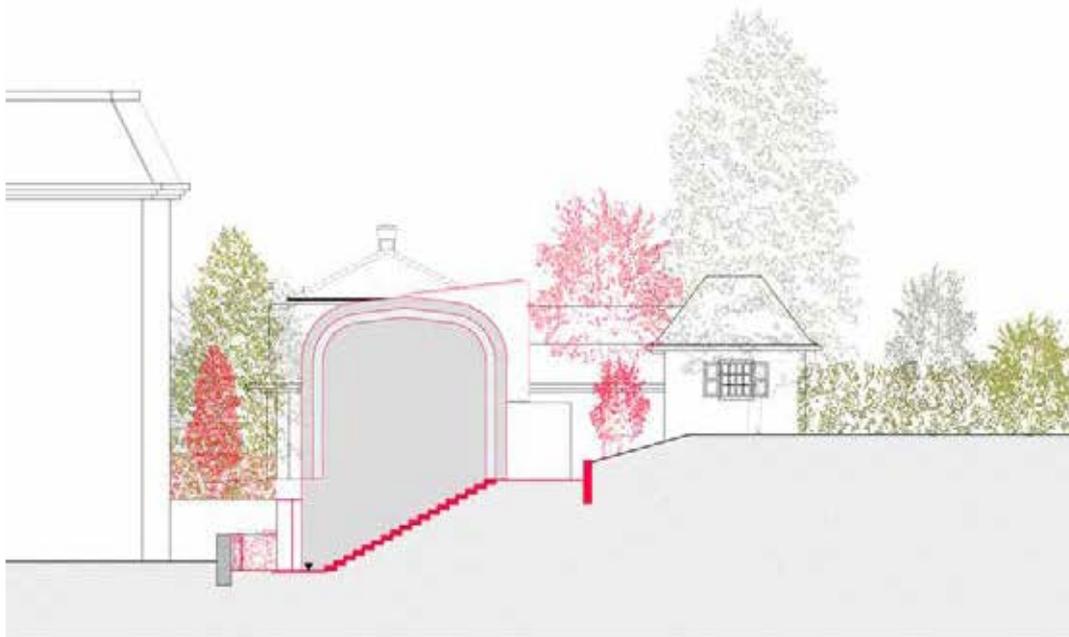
Planausschnitt Ansicht Ost, neue Gebäudeteile und Neupflanzungen rot
